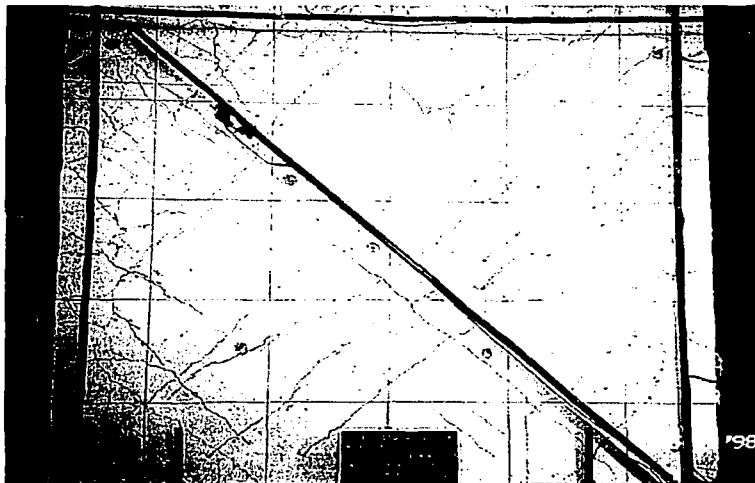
Agrietamiento final en el recubrimiento de concreto
